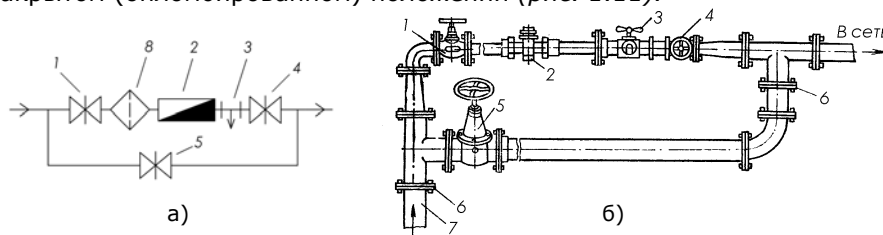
Водомерный узел с обводной линией: а) гидравлическая схема, б) внешний вид; 1, 4, 5 – запорная арматура; 2 – счетчик воды; 3 – контрольно-спускной кран; 6 – фланцевые соединения трубопроводов; 7 – трубопровод ввода; 8 – сетчатый фильтр
